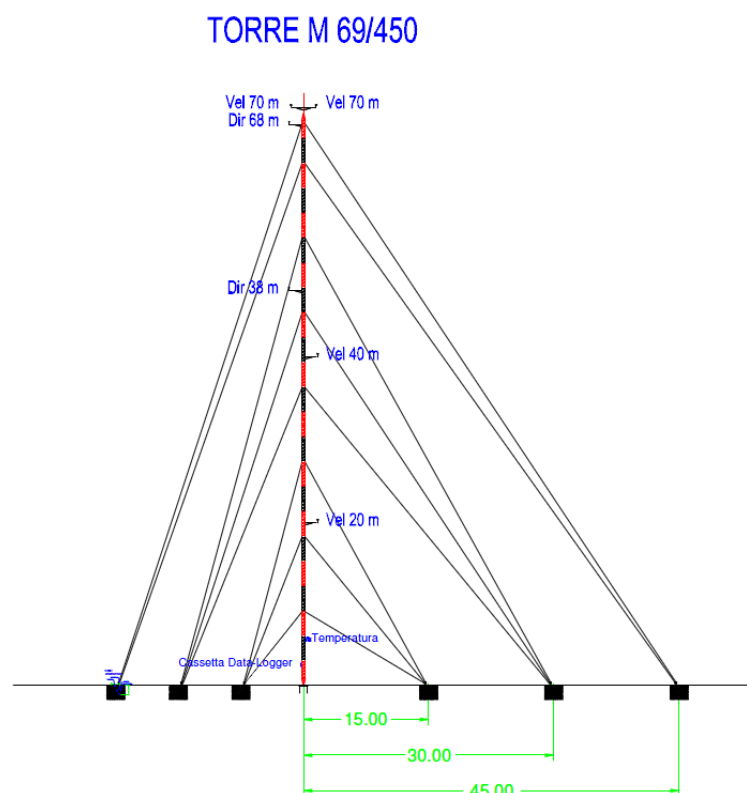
Prospetto dell'anemometro con indicazione dei sensori montati
